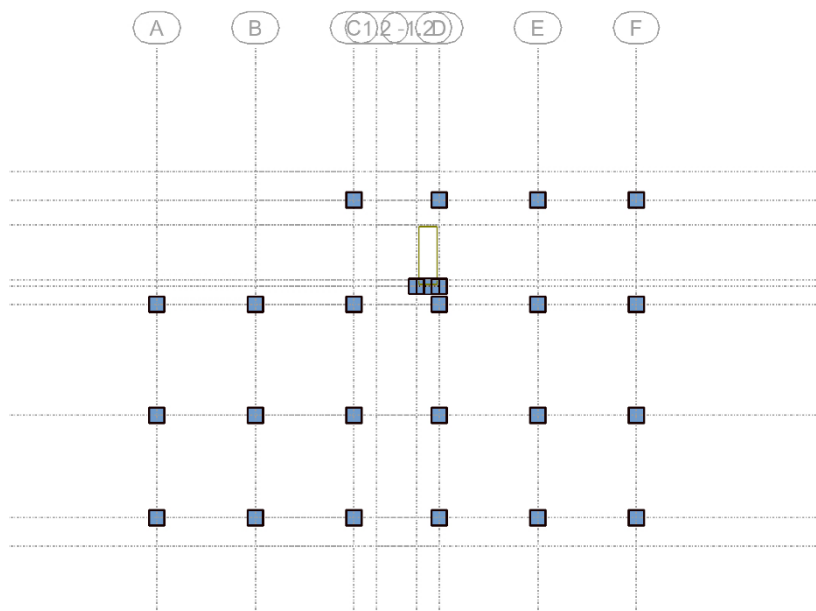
vu en plan fondations du 1ère variante (sans voiles)
